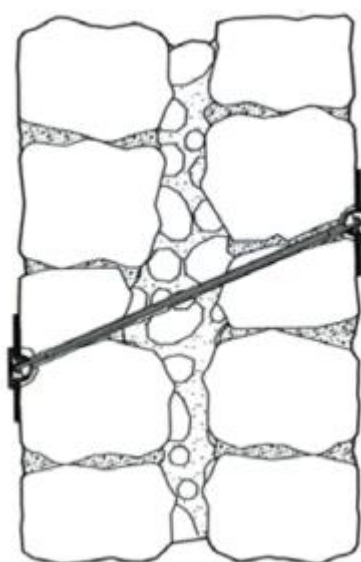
Esquema representativo da aplicação da técnica de reforço de paredes com pregagens transversais (Jo & Disserta, 2010)
